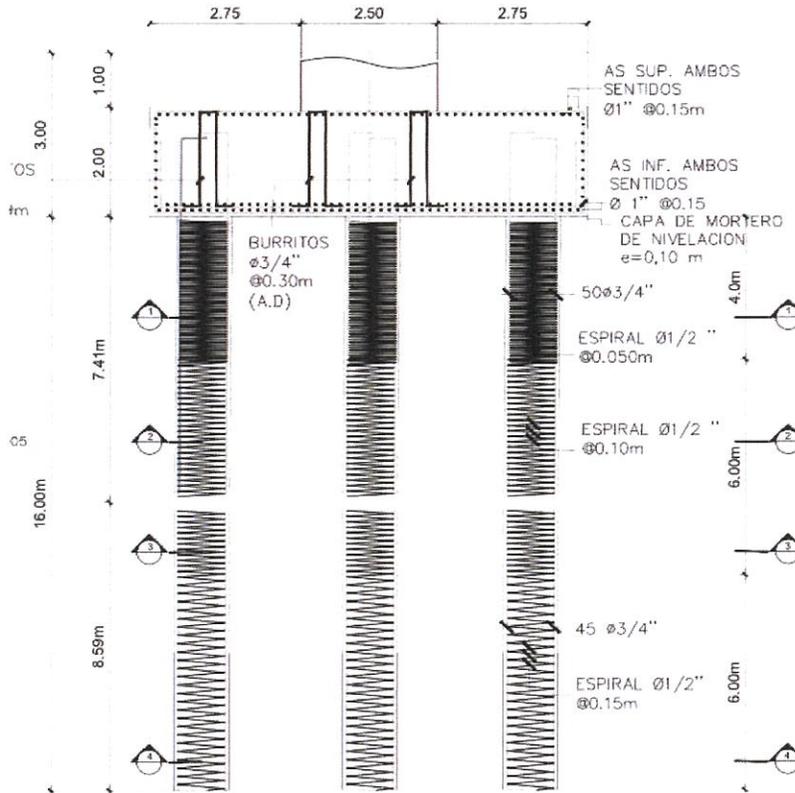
Esquema de Fundación de Estructura de Estación sobre Zapatas en Pilotes
